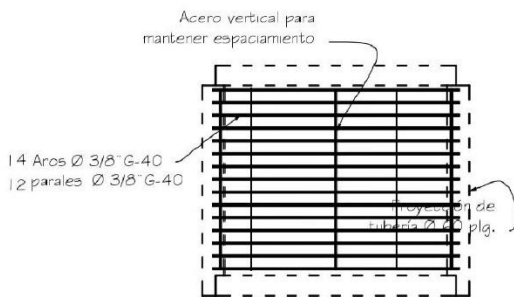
Tubos de concreto reforzado Ø de 60" clase II
